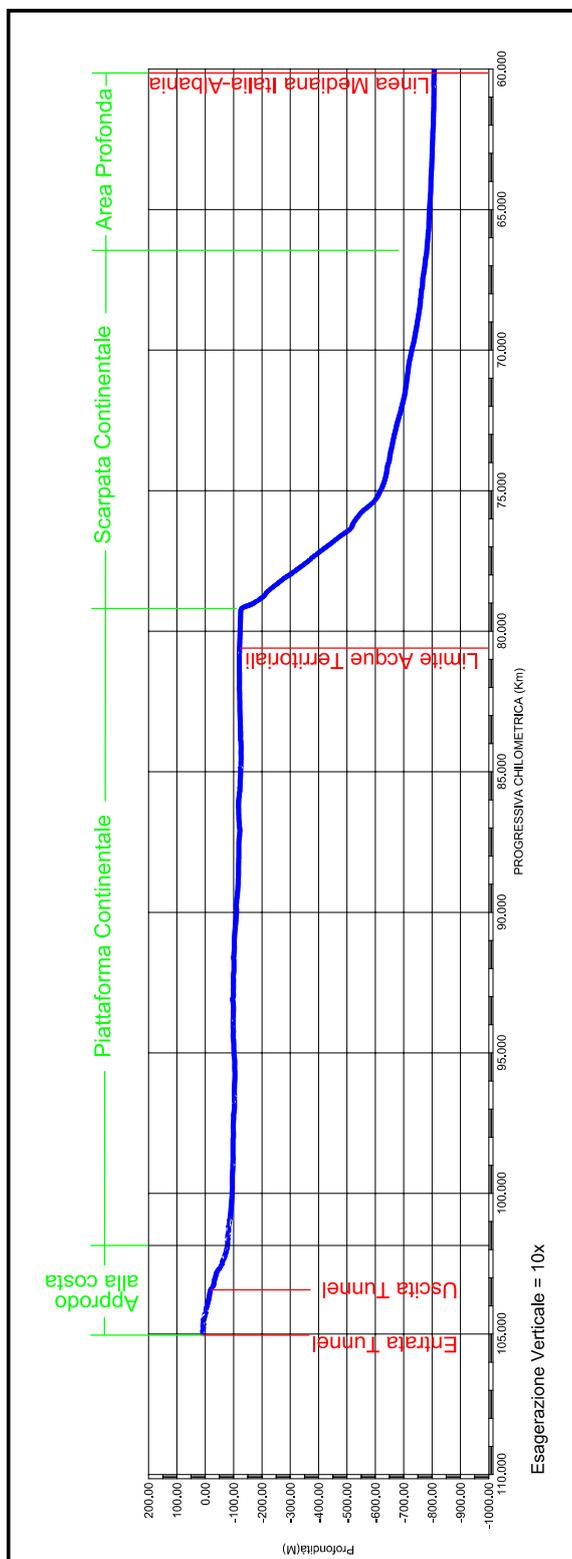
Profilo del fondale lungo il tracciato della condotta
